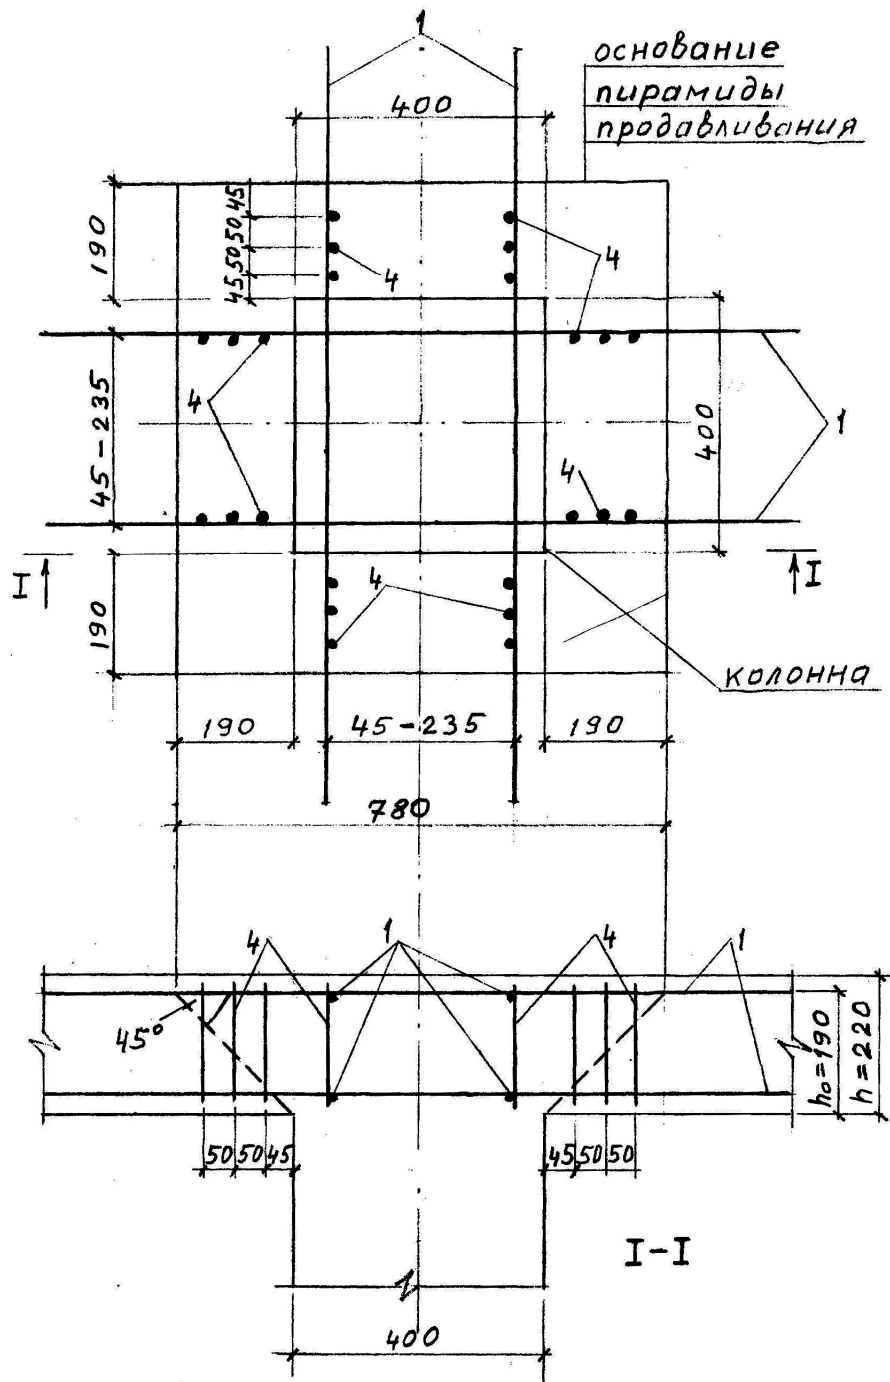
Расчетная схема плиты на продавливание, армирование сопряжения плиты
